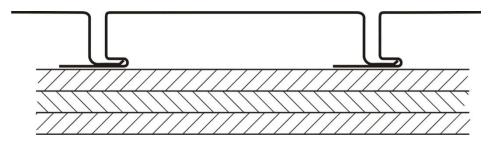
Querschnitt durch ein, auf eine Unterkonstruktion befestigtes, selbsttragendes Profil (Steckfalzpaneel)
